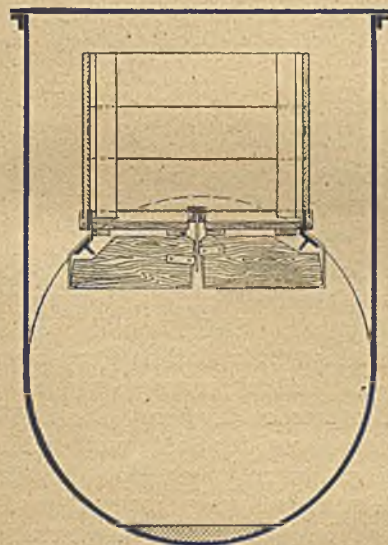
Querschnitt durch die Versuchsstrecke mit eingebautem Gesteinstaubbruch nach Bauart a.
